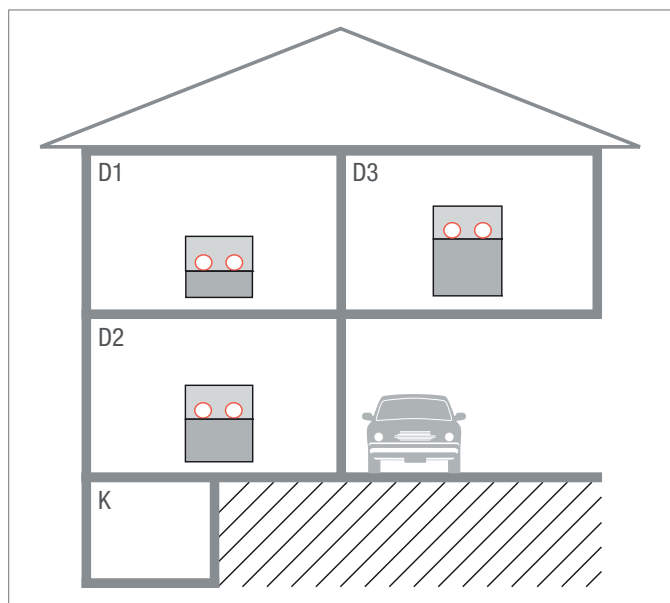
Estructura de las capas de aislamiento mínimas para el sistema RAUTHERM SPEED.
